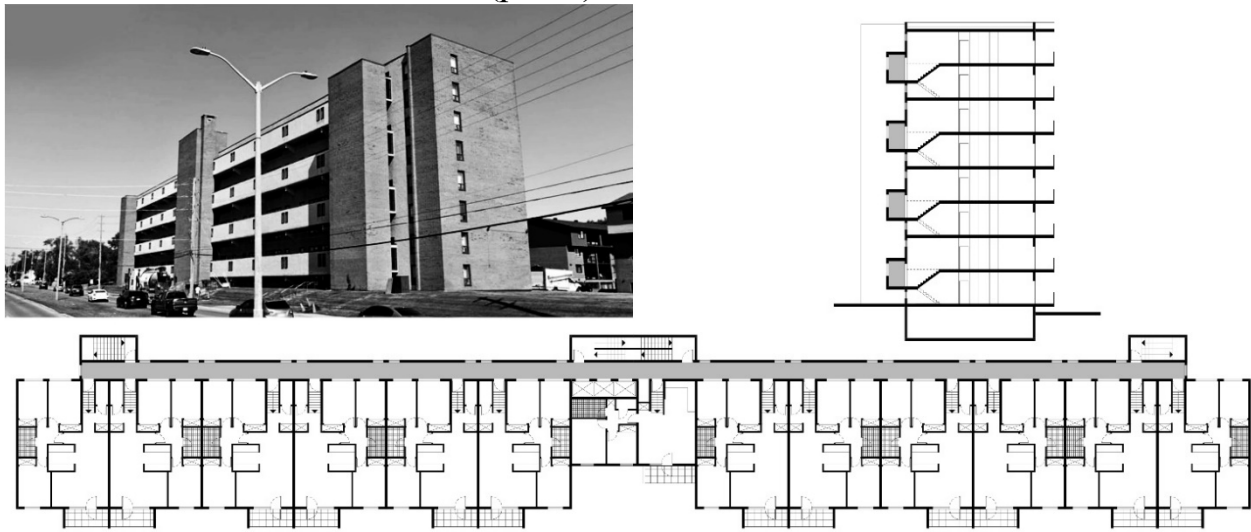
Галерейний 8-поверховий будинок з апартаментами (Navaho Apartment (hotel). Загальний вигляд зі сторони магістралі, план типового поверху, розріз. (Фото [15], креслення - Яблонська Г.Д.)
